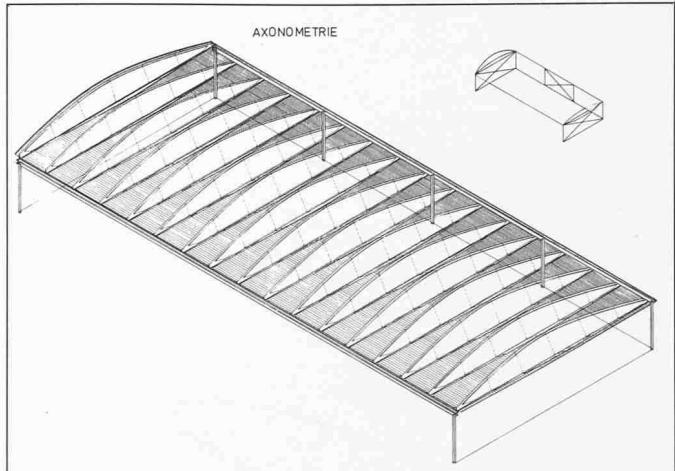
Die Dachkonstruktion ermöglicht grosse seitliche Öffnungen
